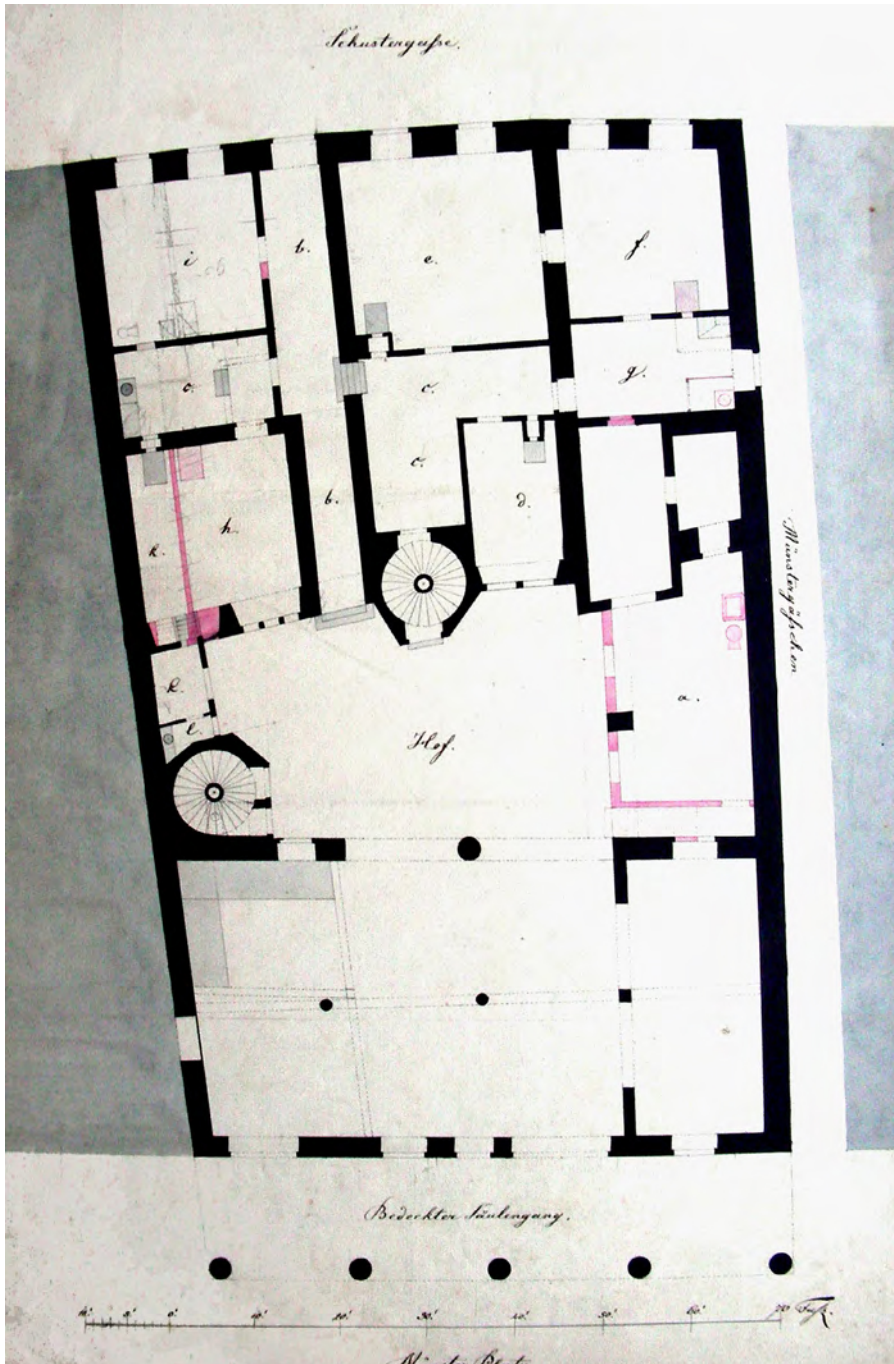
Historisches Kaufhaus, Grundriss des Erdgeschosses mit Altbau an der Schusterstraße (oben), Innenhof und Neubau am Münsterplatz. Plan: Mitte 19. Jahrhundert (Süden oben), Münsterbauhütte Freiburg.
